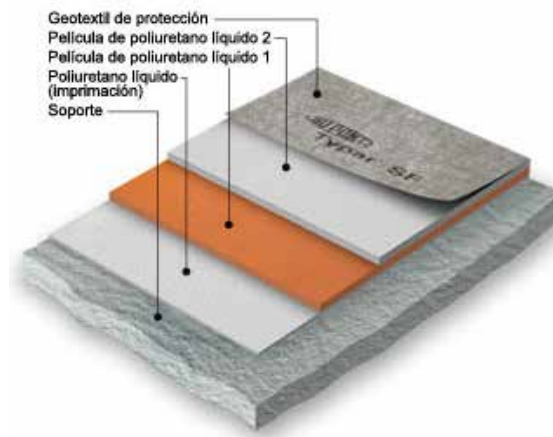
Impermeabilización de techo. <http://www.nortena.es/pl3.html> (2017)
